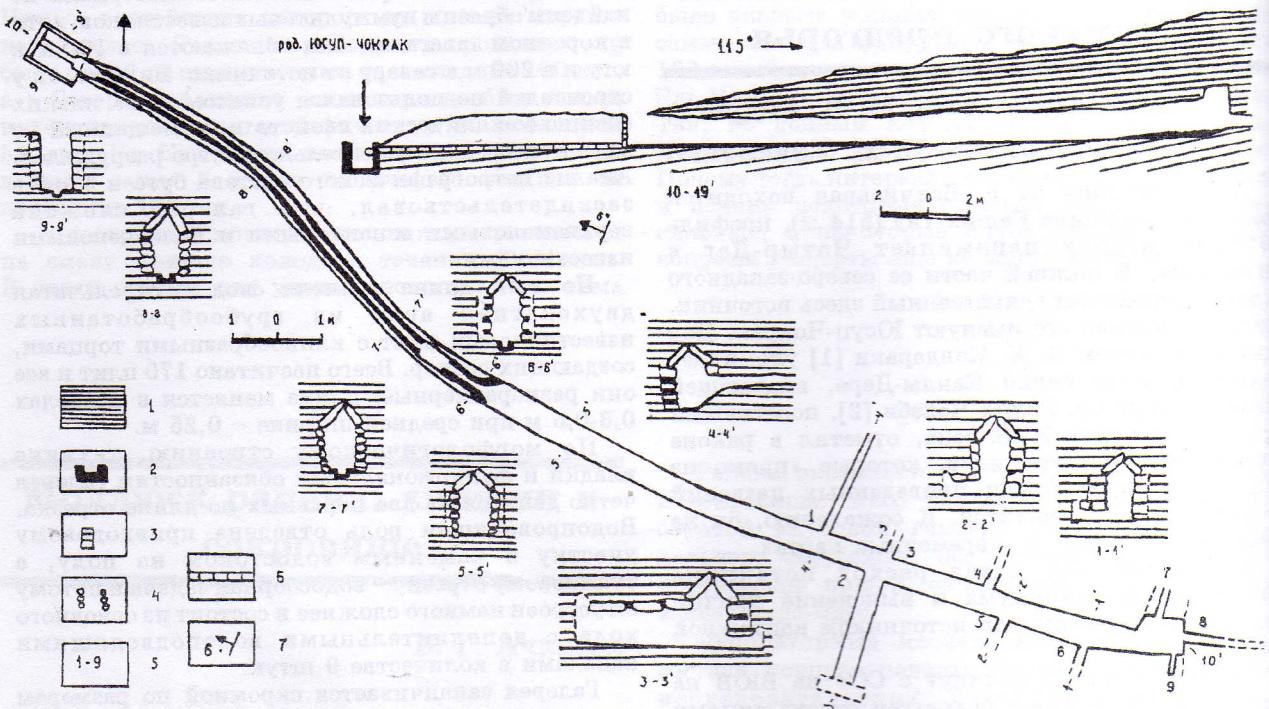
План, продольный (10-10') и поперечные (1-1' – 9-9') разрезы гидротуннеля под Бешик-Тау.
